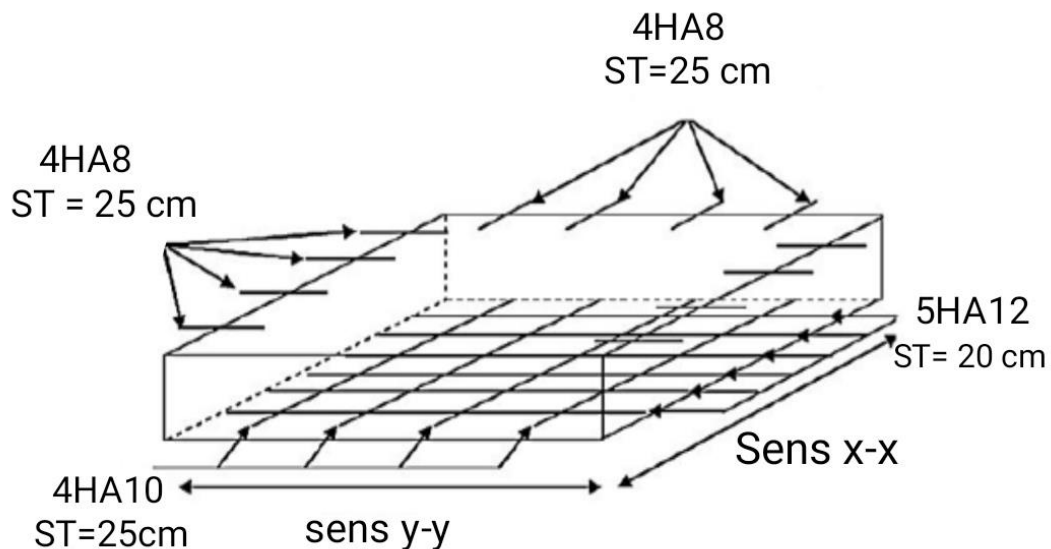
Schéma de ferrailage de la dalle sur quatre appuis (RDC)
